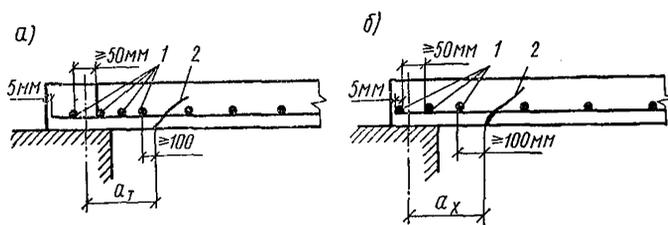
Примеры анкеровки растянутых стержней арматуры на опорах плит из ячеистого бетона
